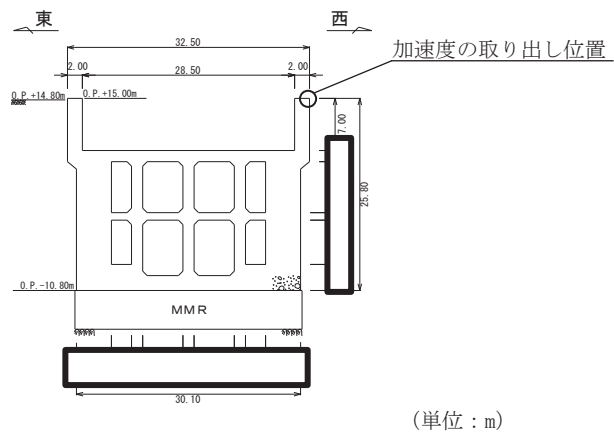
(2) 海水ポンプ室断面図 (スクリーンエリア) (A-A 断面)
